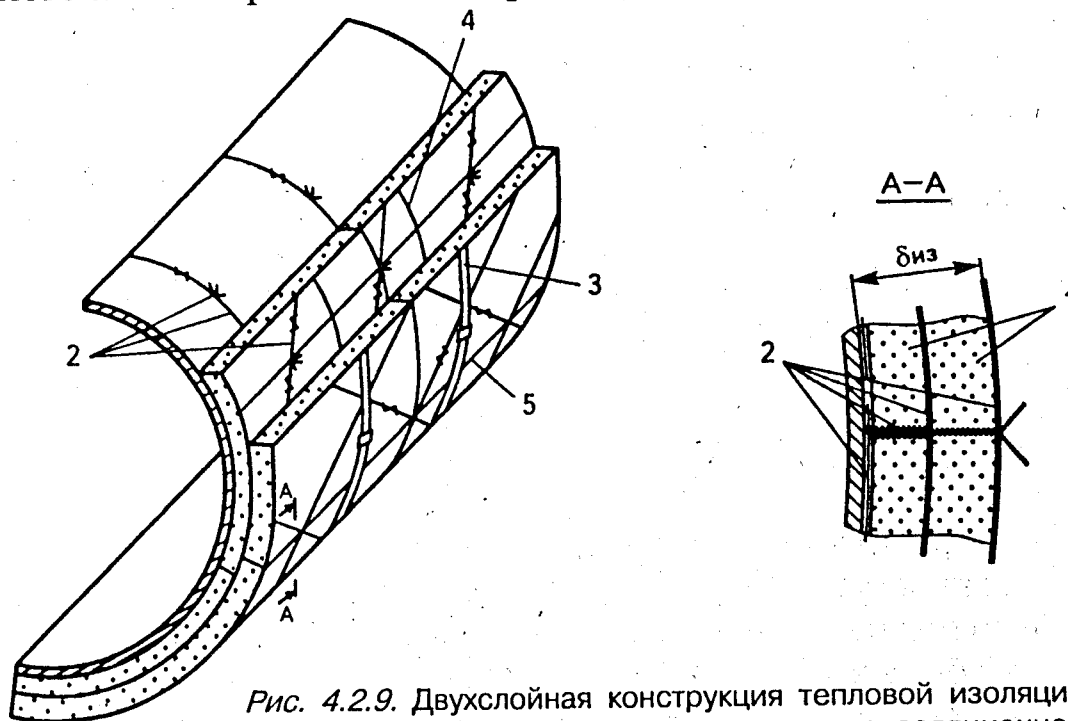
Двухслойная конструкция тепловой изоляции горизонтального аппарата с креплением теплоизоляционного слоя на проволочном каркасе:
